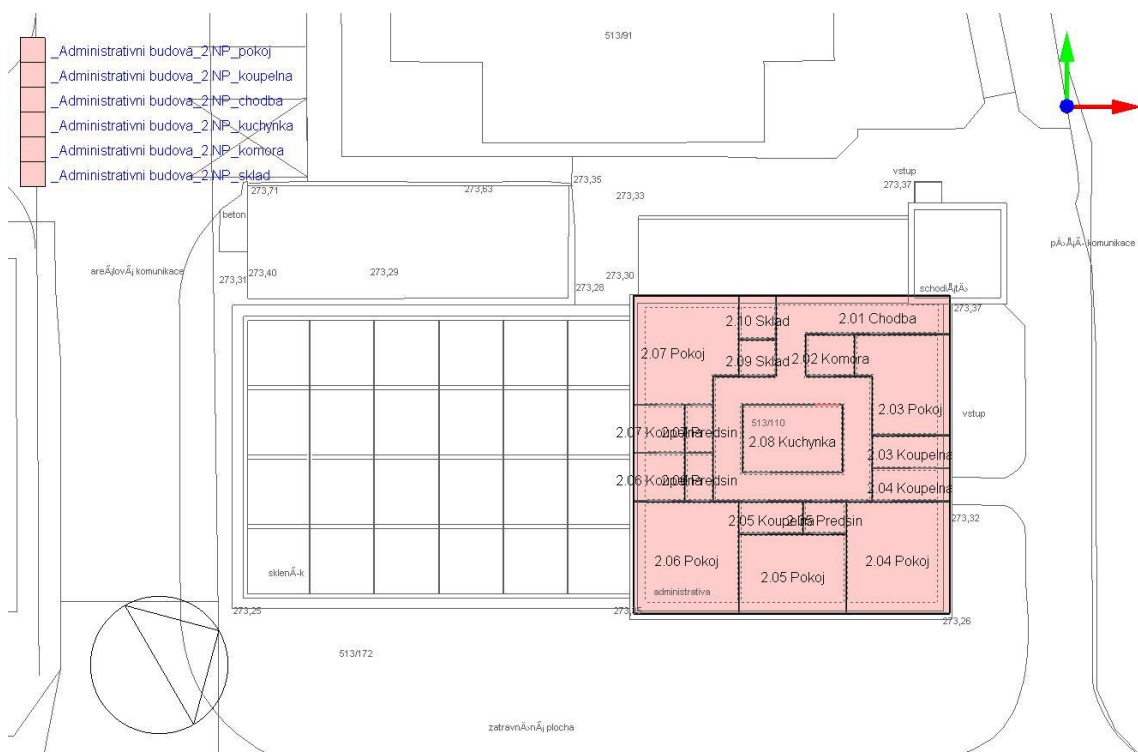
Layout programu DesignBuilder – okolní zástavba (pohled shora)
